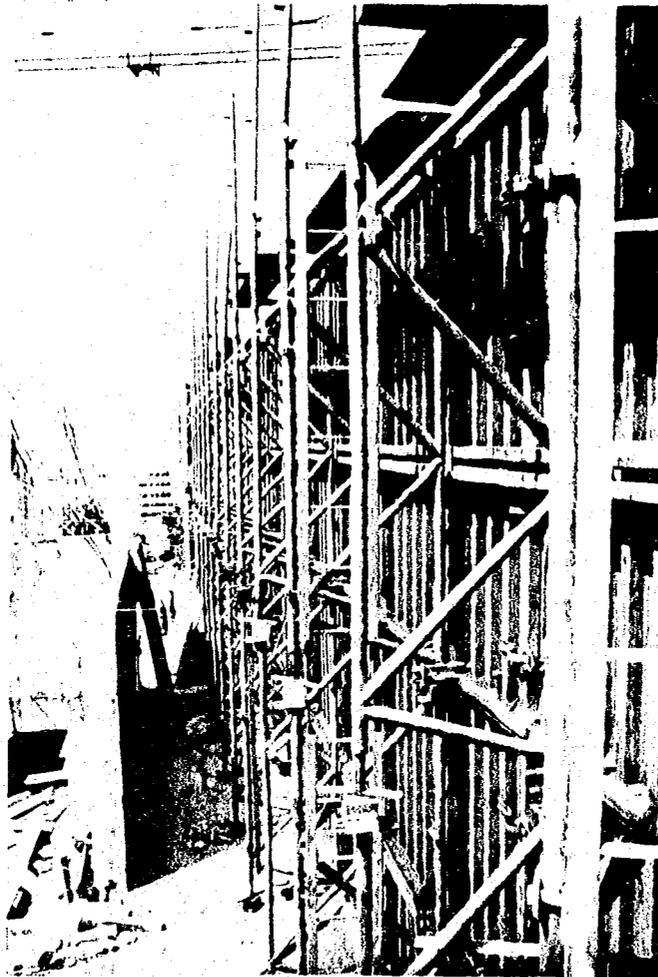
Cimbra de un muro de 21.5 mts x 5 mts. Realizado con cimbra metálica Outinord, el colado de concreto se realizó en una sola pieza.
